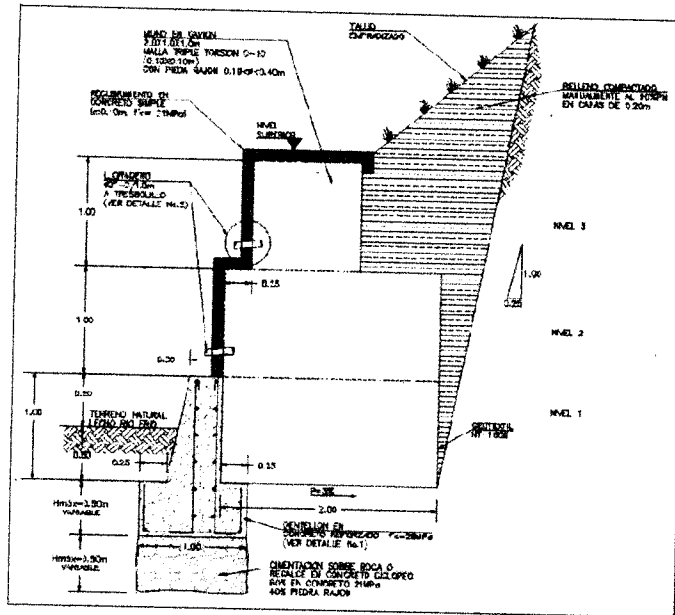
Muro Gavión tipo II y detalle dentellón (Propuesto por Gradex Ingeniería S.A.)
